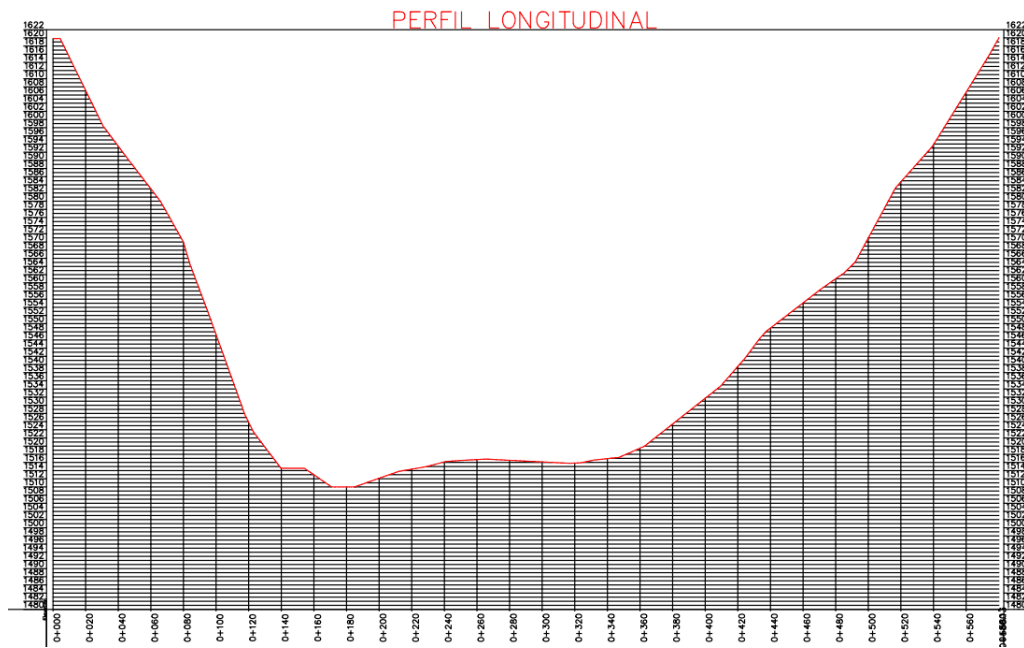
Perfil longitudinal del eje de emplazamiento Murallas Viejas, Civil 3D
